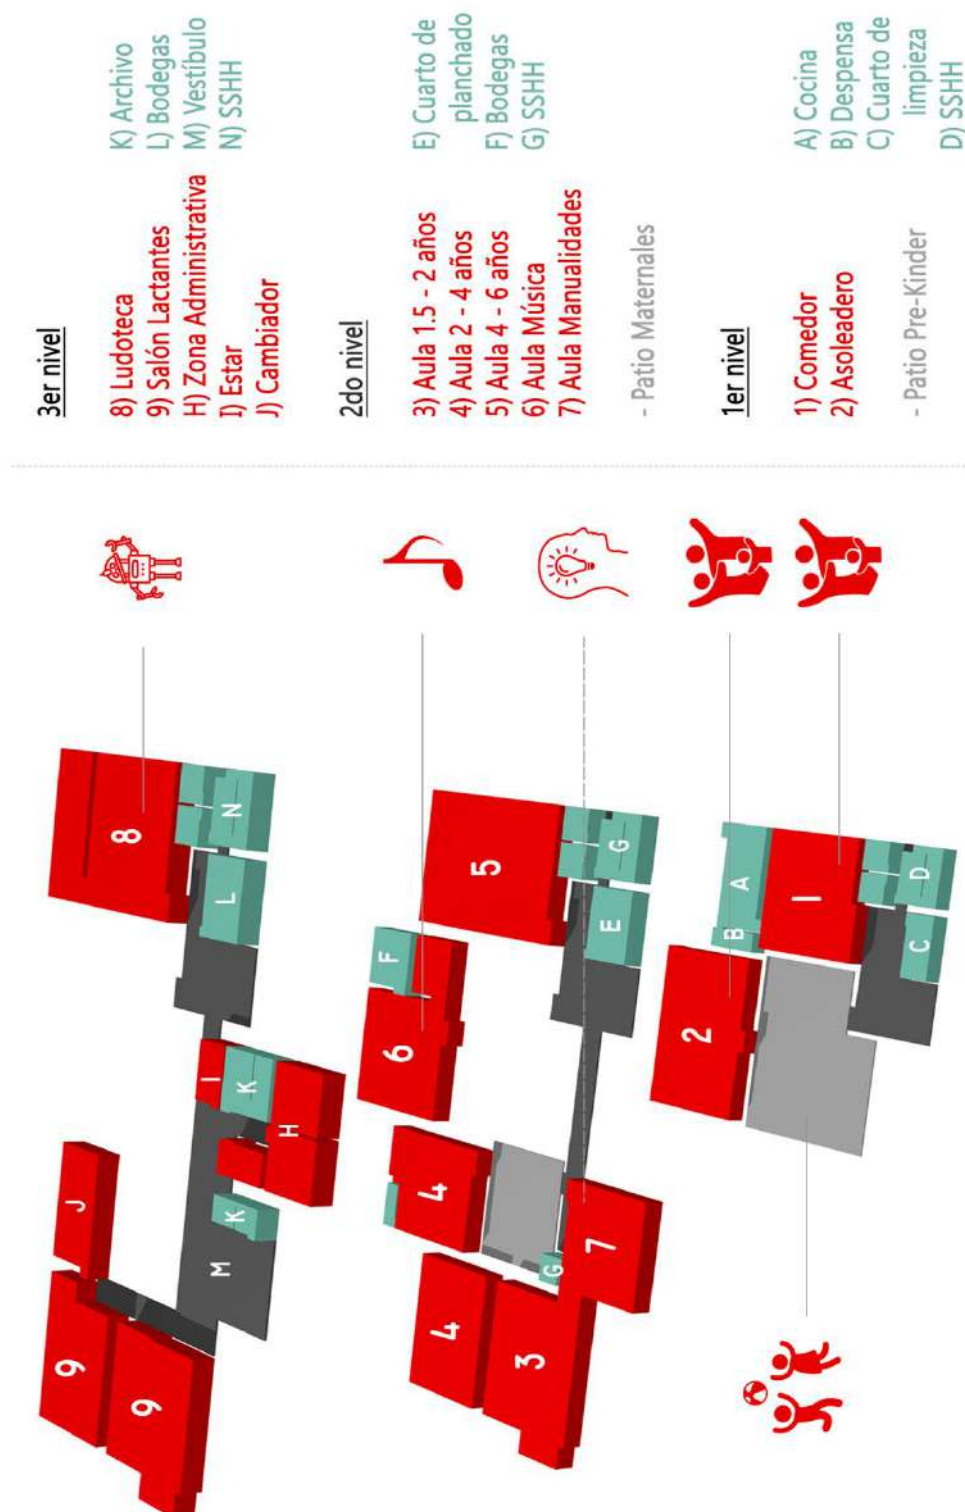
Programa Arquitectónico Ilustrado de la Guardería, elaboración propia.
